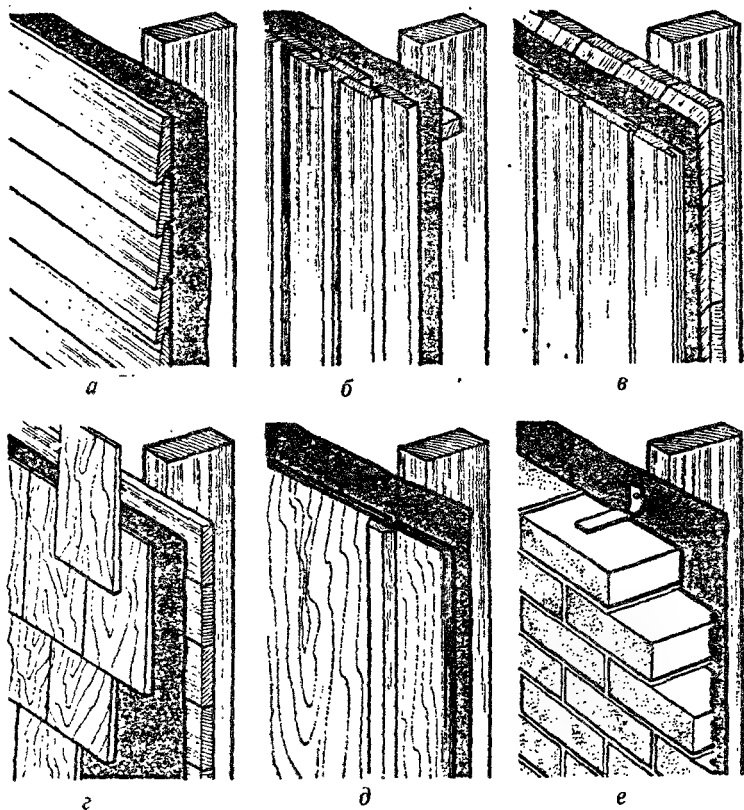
Варианты наружной обшивки стен панельной сауны:
